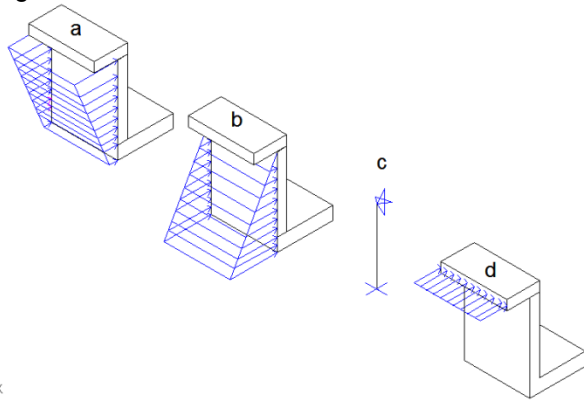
(a) Carga sísmica sobre muro. (b) Empuje activo sobre muro. (c) Modelo estructural para muro. (d) Carga sobre viga.
